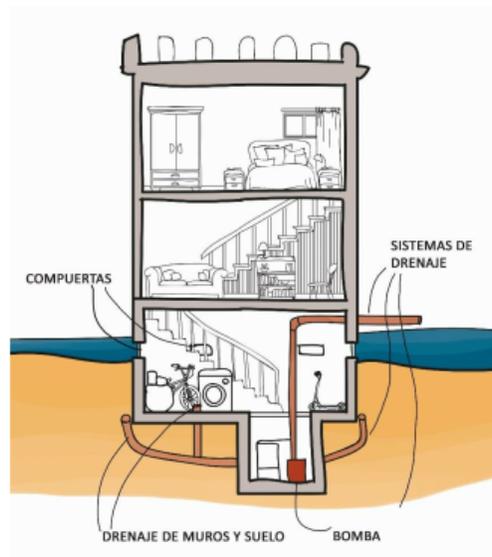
Sistema de drenaje de muro (ferreteriicornellana.com)
